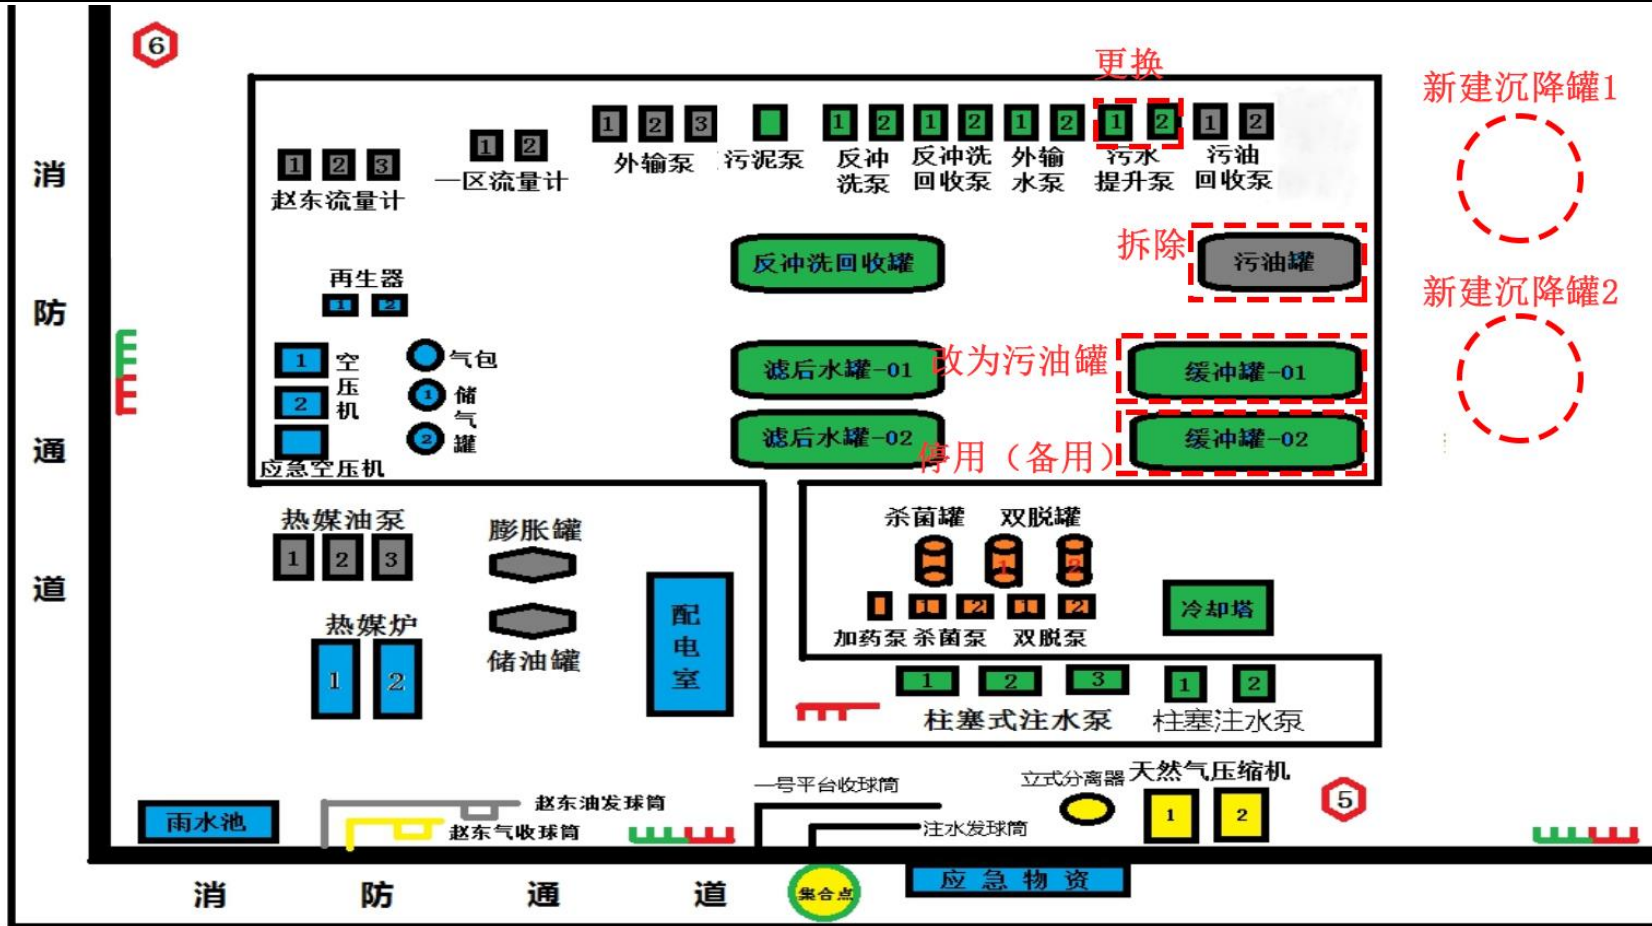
本项目调整改造平面布置图（平台为一层）
